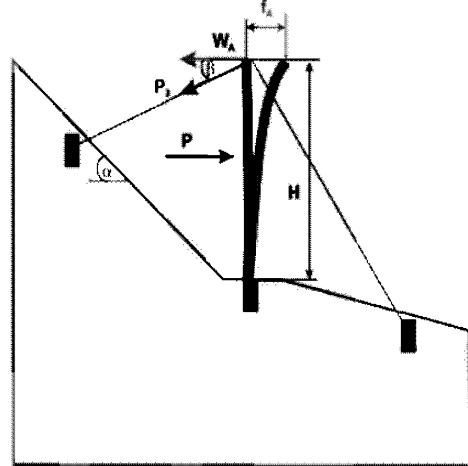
Схема для определения усилий в верхних по откосу или склону поперечных растяжках
